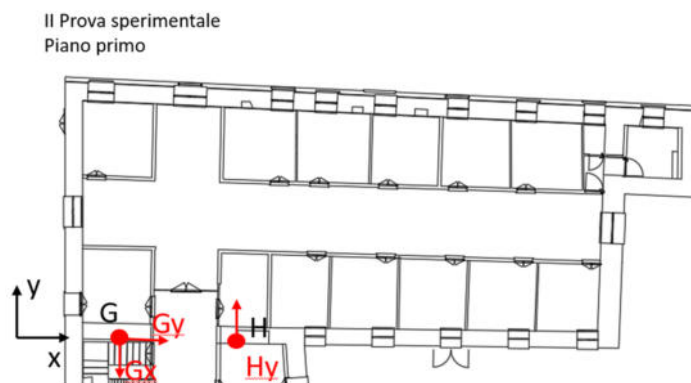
Disposizione degli accelerometri nel piano primo dell'edificio.
